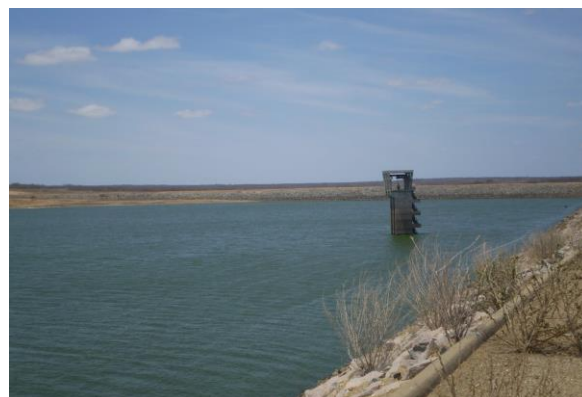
Vista de montante para barragem - Detalhe da torre de comando. Fonte: Google Earth
